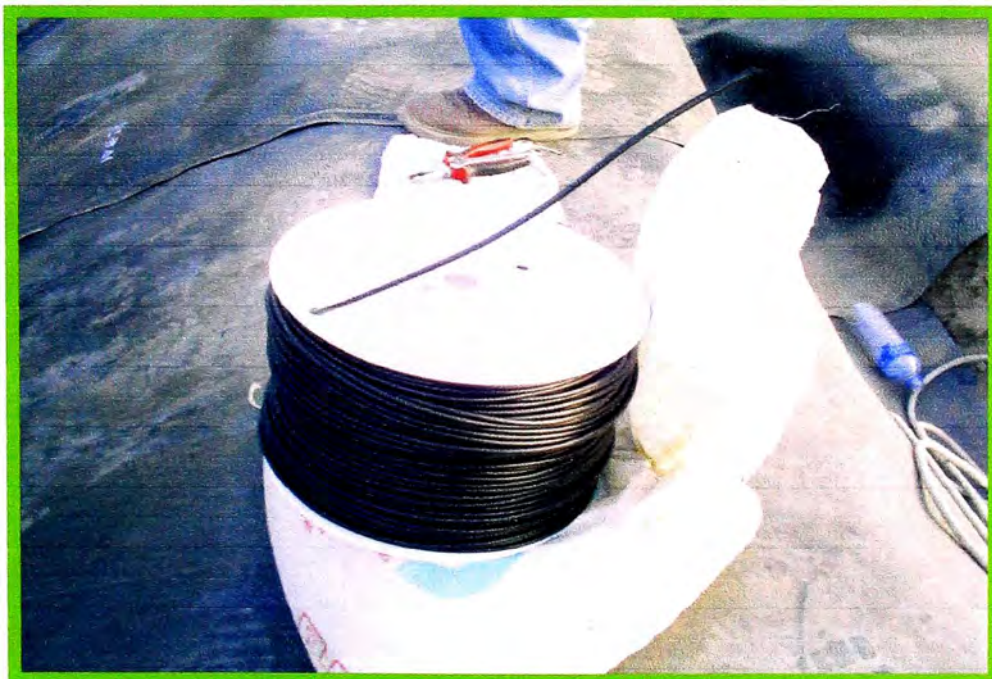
Soldadura para geomembrana por el Sistema de Extrusión
